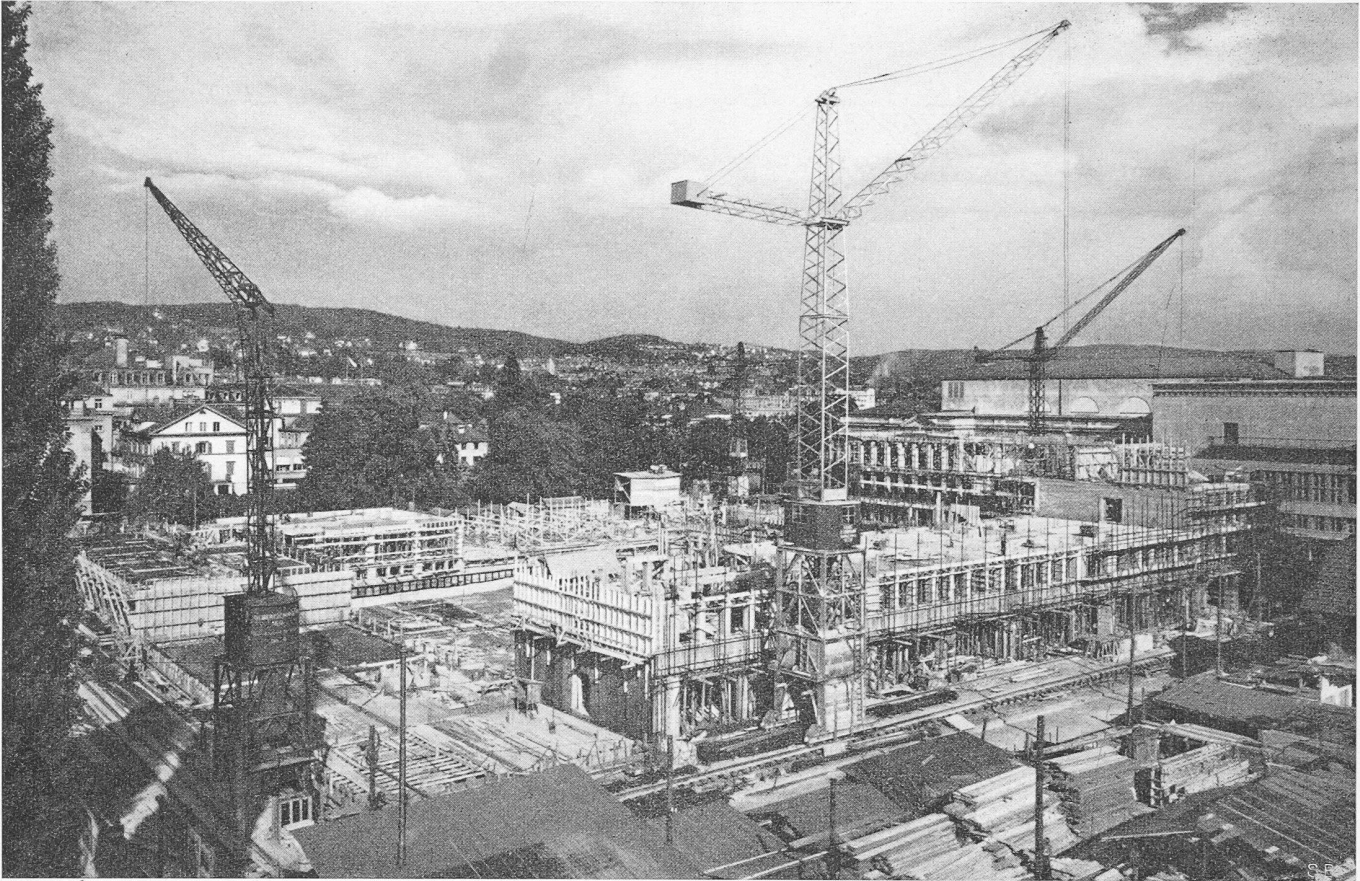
Die Baustelle aus Westen, am 27. Mai 1947 (rechts Tonhalle und Kongresshaus)
